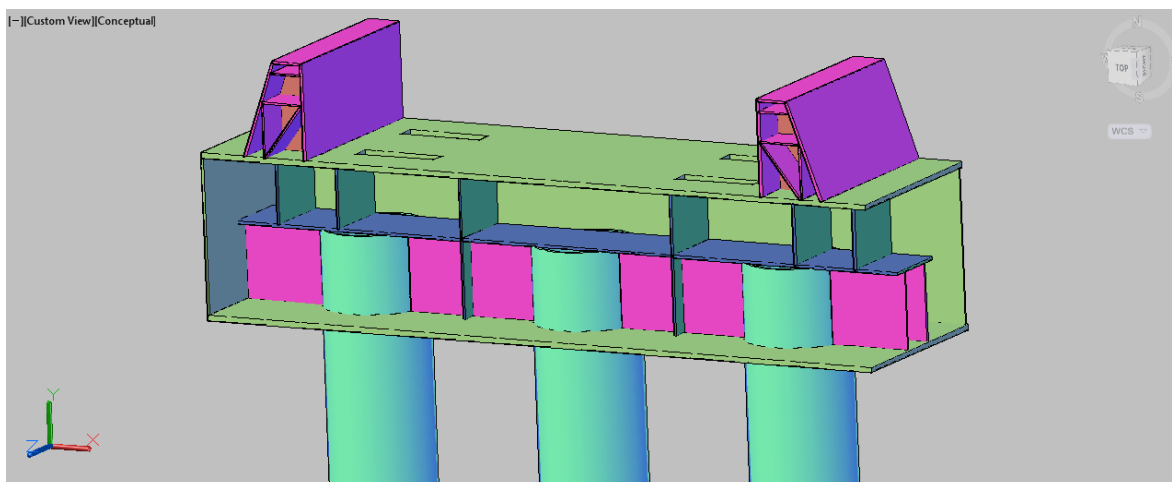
Ilustración 3D de las pilas P1 a P6 del puente (Fuente: Elaboración propia)
